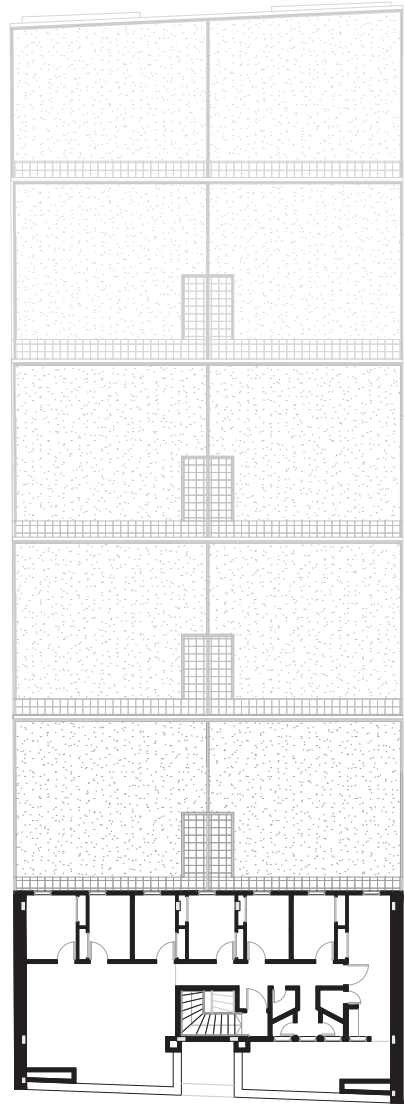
Segunda planta del cuerpo elevado cota 12,20m
